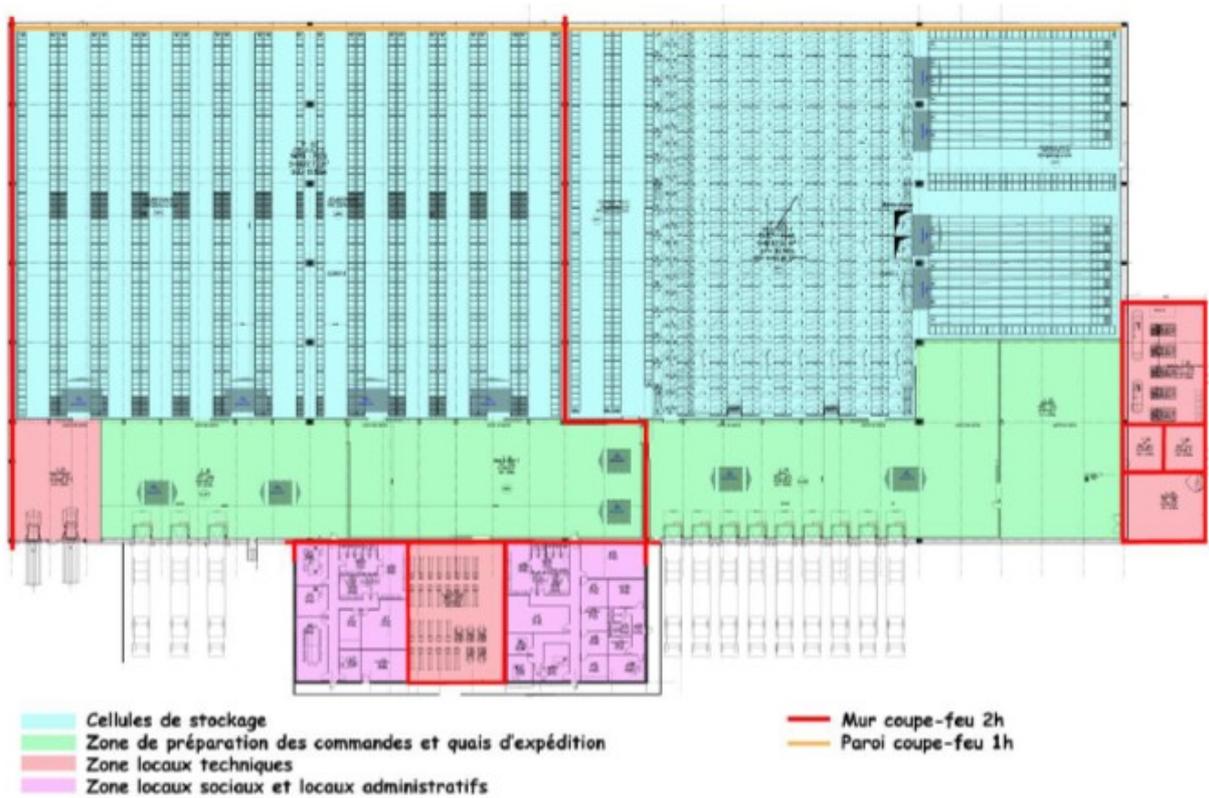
Plan du site et activités (source: dossier de demande d'autorisation p 14)
